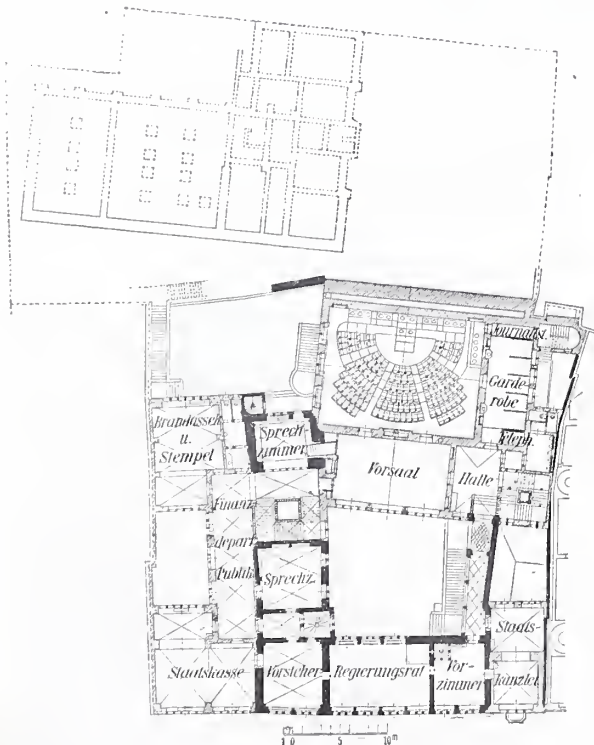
Grundriss vom I. Stock 1:800.
